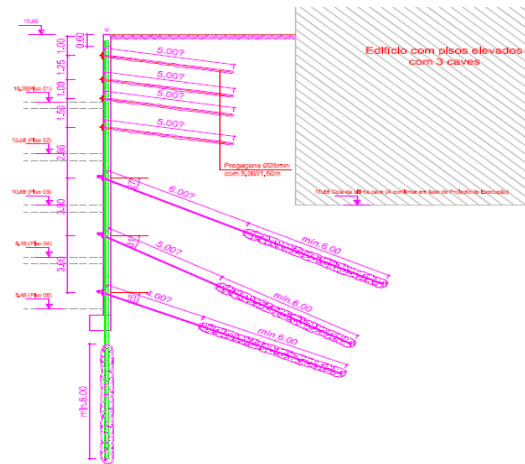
Pregagens nos dois primeiros andares de cave, no alçado Este
